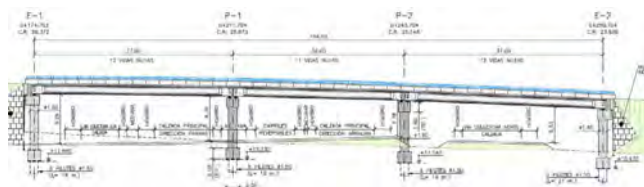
Alzado del tablero de la estructura E-2. Paso superior con tablero de gran ancho.
